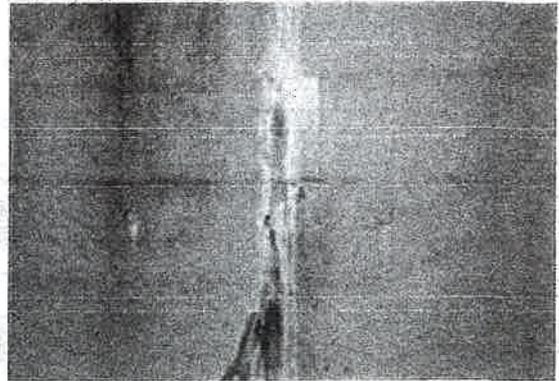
擁壁の析出物を伴う幅0.3mmのひび割れ
